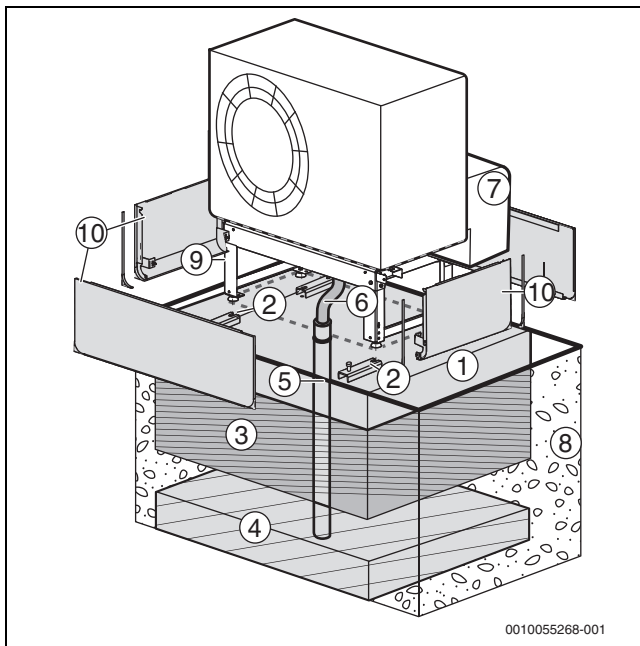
Befestigung der Wärmepumpe, Flächenfundament (Maße in mm)
